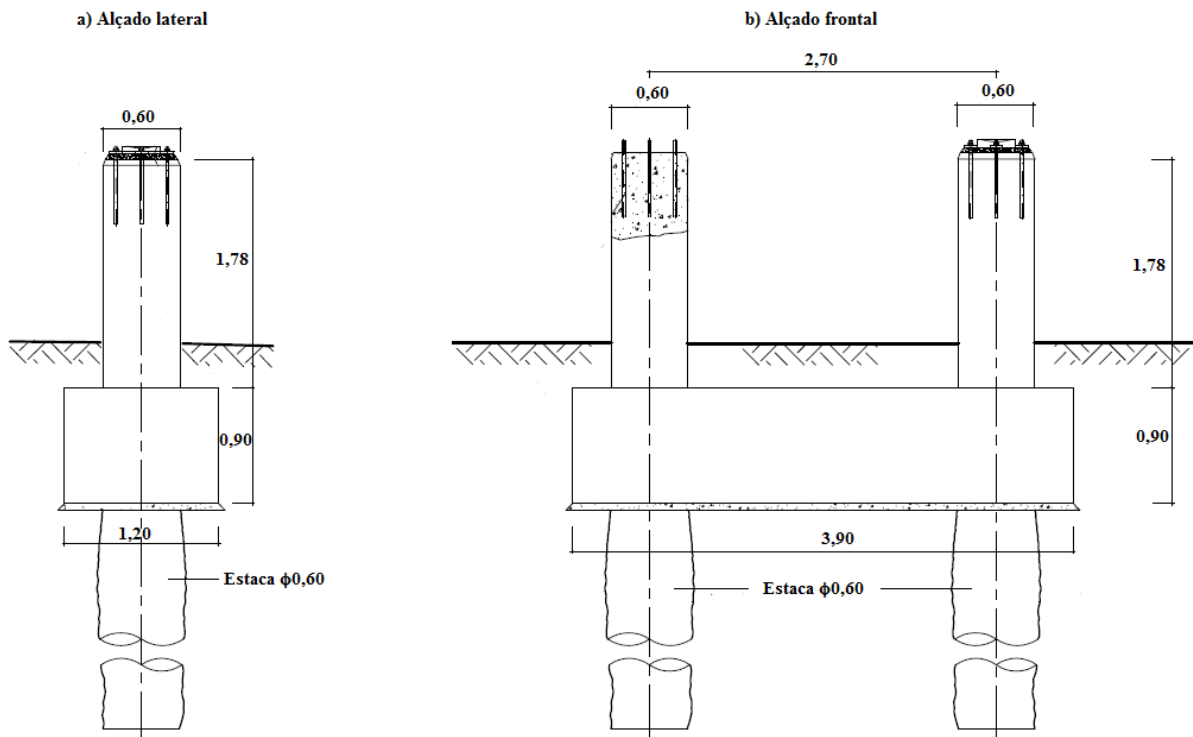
a) Alçado lateral do pilar P1; b) Alçado frontal do pilar P1 [25].
